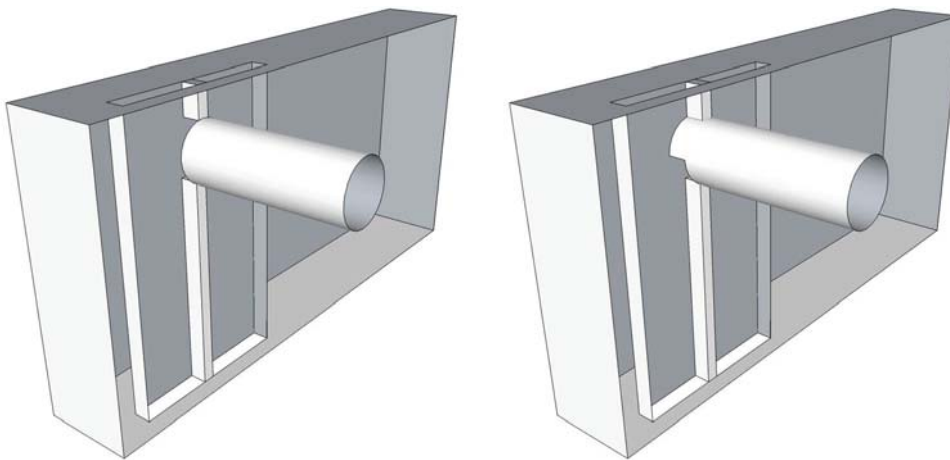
Einbaumöglichkeiten des Verbindungsrohrs an den Lüftungskanal am Wandanschlussstück mit bündigem Anschluss (links) und mit angeschnittenem Kunststoffrohr
